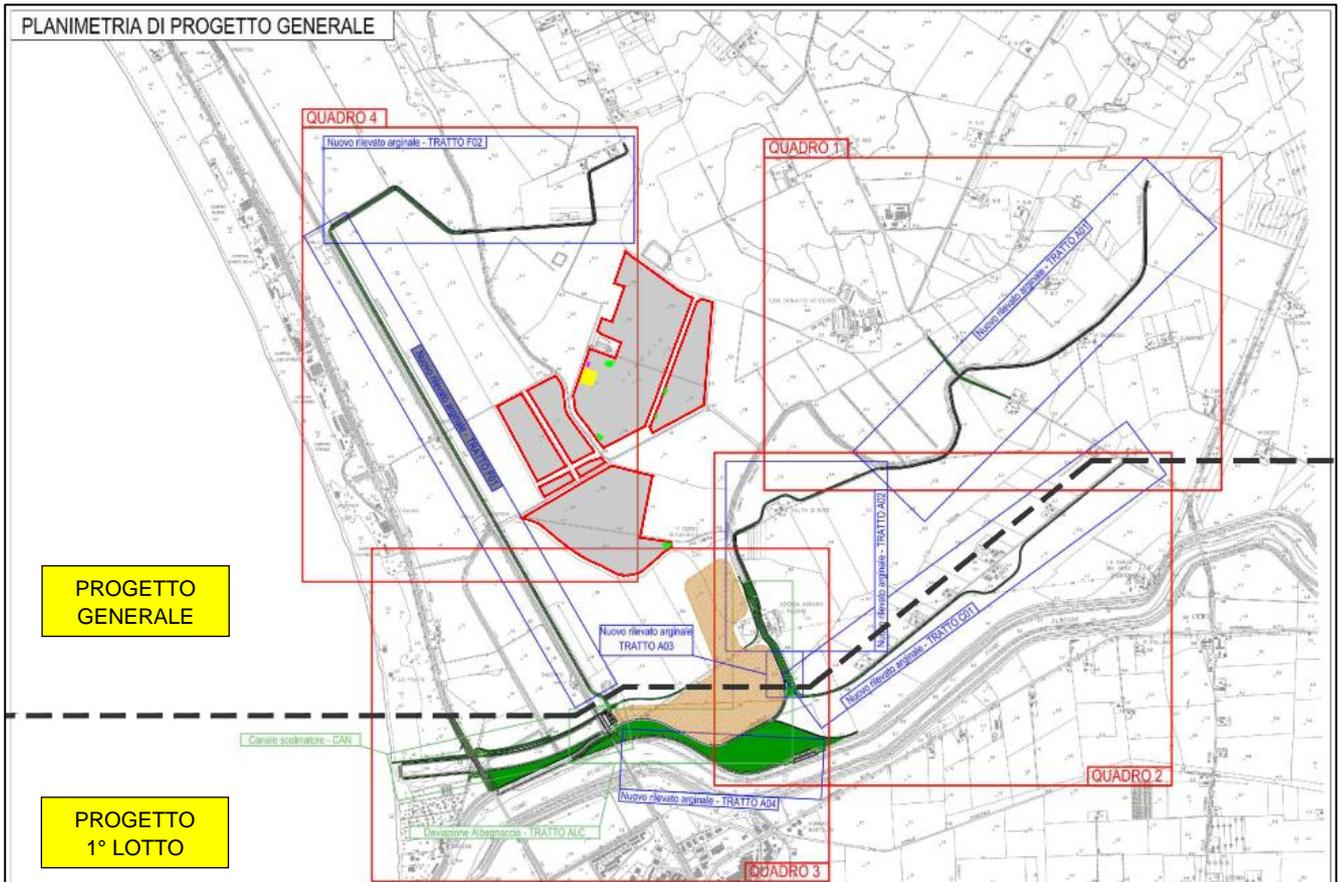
ESTRATTO PLANIMETRIA PROGETTO DEFINITIVO GENERALE – LIMITE DI OCCUPAZIONE OPERE 1° LOTTO E OPERE DEL PROGETTO DEFINITI VO – AREA DELL’IMPIANTO
